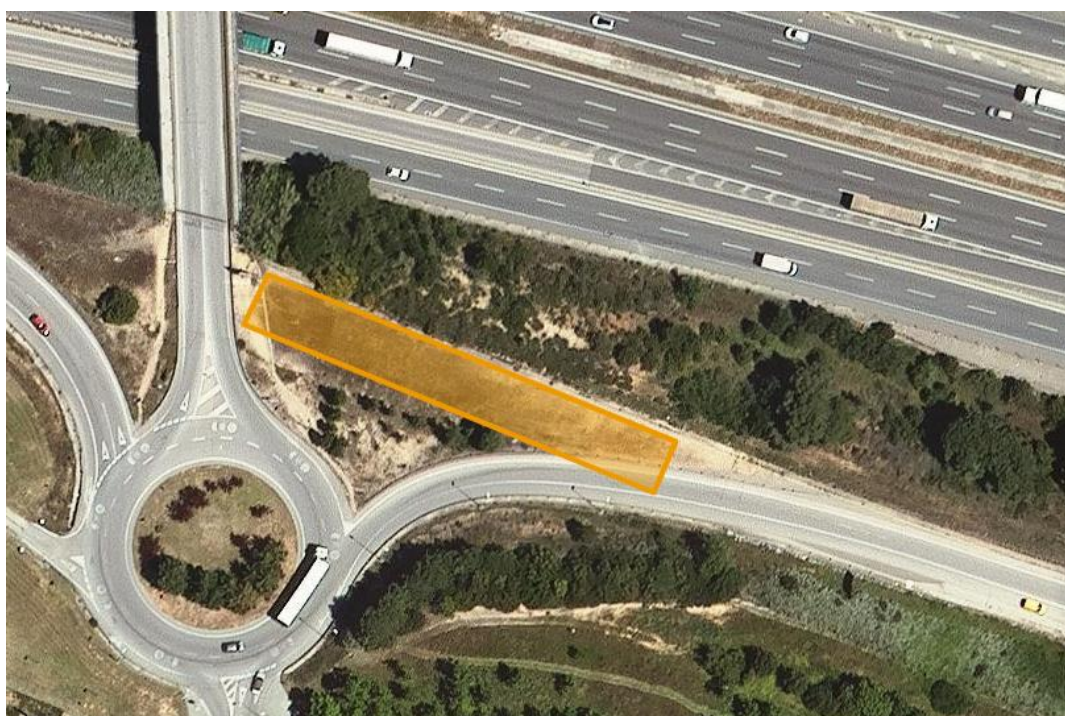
Planta Estructura ( 80 x 10) en zona de Muntatge SUD
